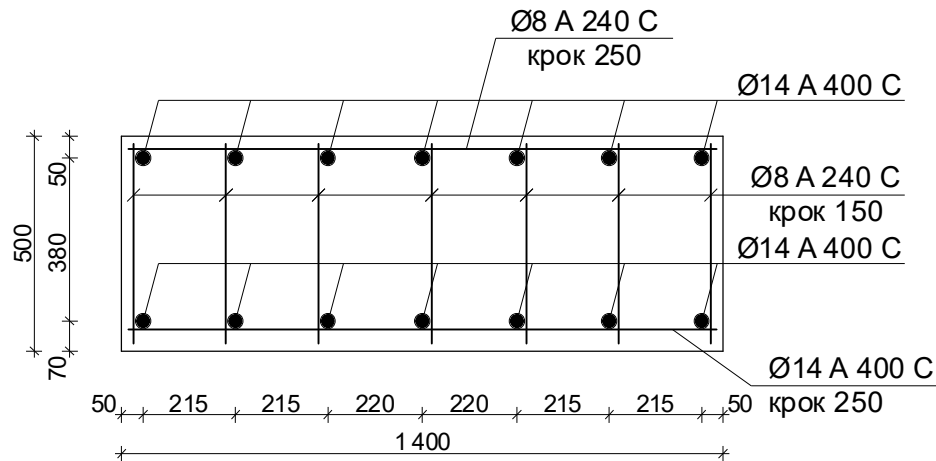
Схема розміщення арматури у ростверку фундаменту з бурових паль
